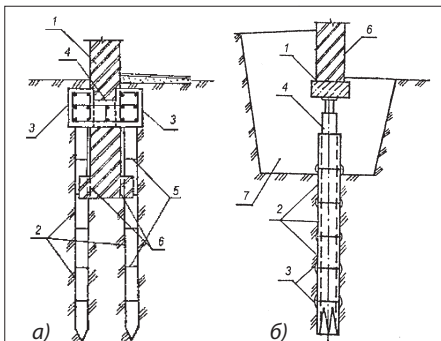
Усиление фундаментов с использованием вдавливаемых многосекционных свай:
